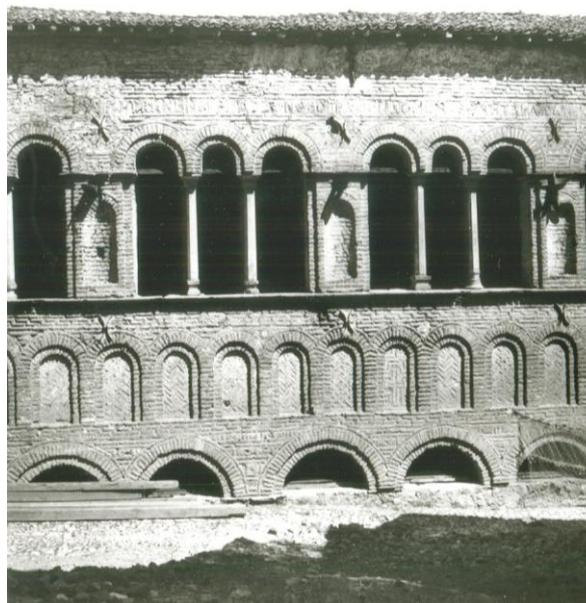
Tirantes hechos de railes de ferrocarril, colocados en 1946/47. Vista de la fachada oeste del exonártex. También se puede observar la capa de sedimentos que completamente rellena el pórtico de la planta baja de la estructura.
